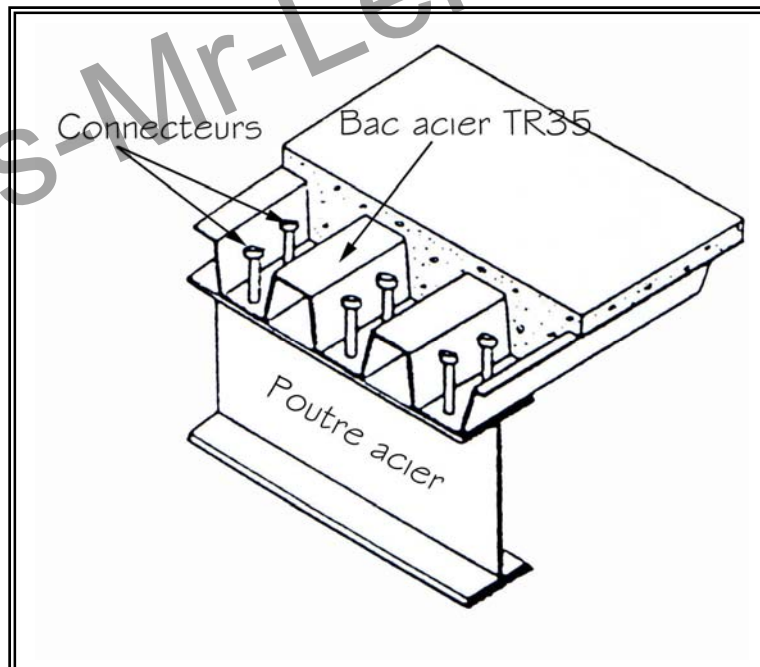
Plancher mixte collaborant avec dalles en béton armé sur coffrage perdu.
